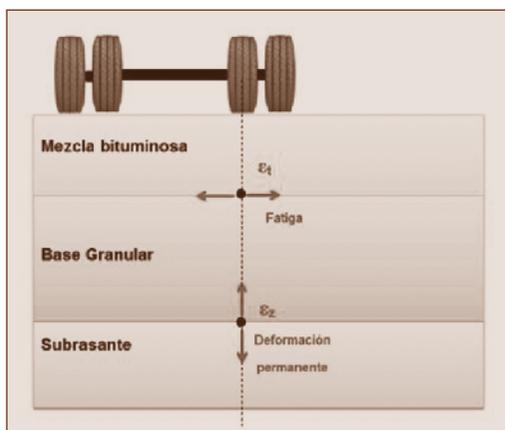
Sistema elástico multicapa para diseño mecánico de pavimentos flexibles.
